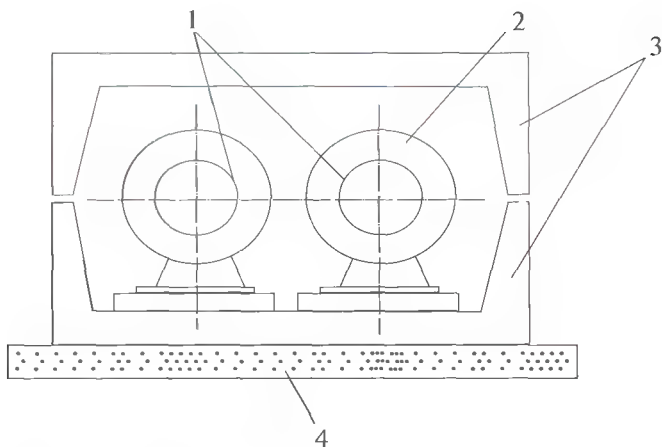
Унифицированный сборный железобетонный непроходной канал:
